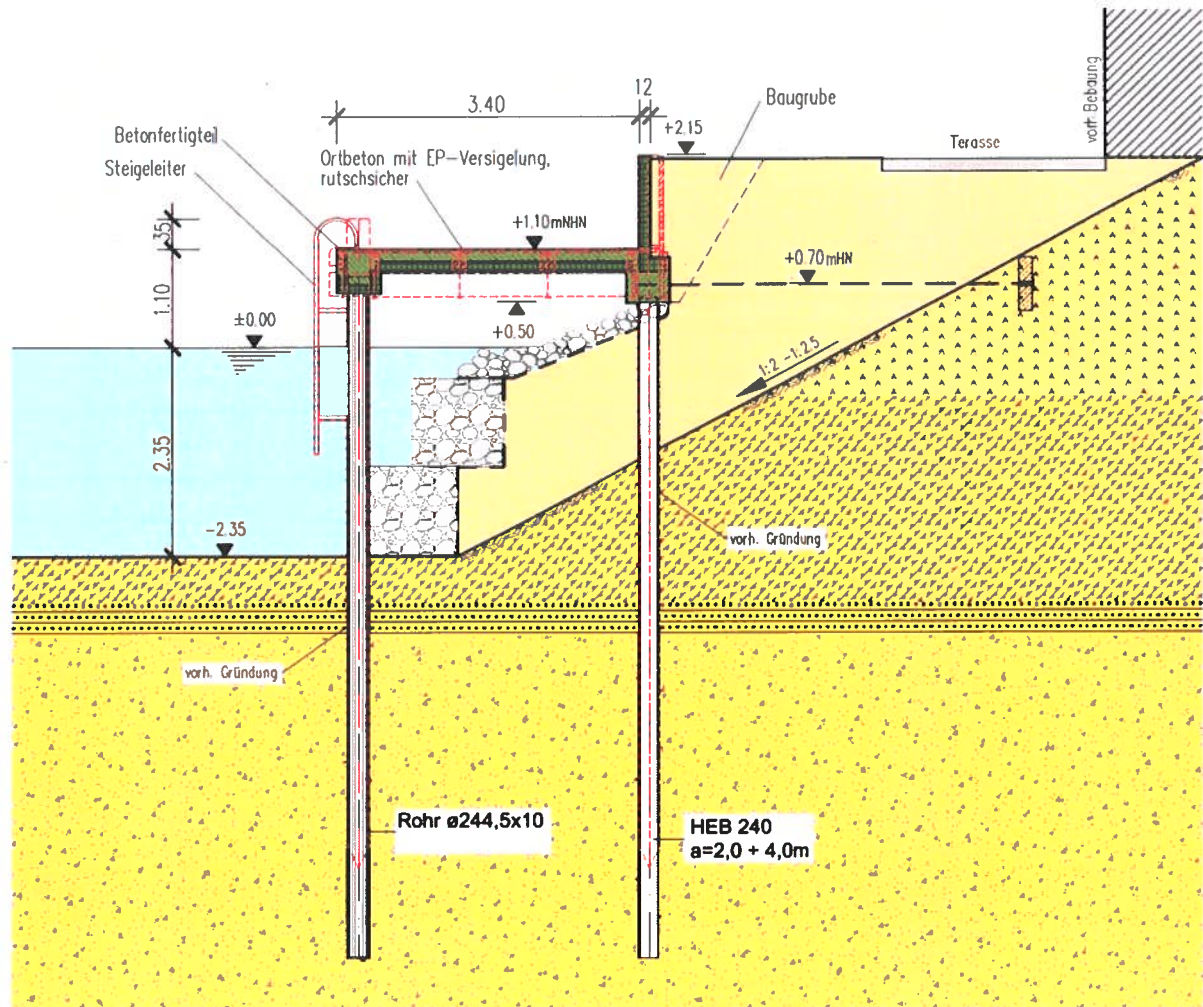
Betonüberbau mit Einbindung der vorhandenen Verankerung
